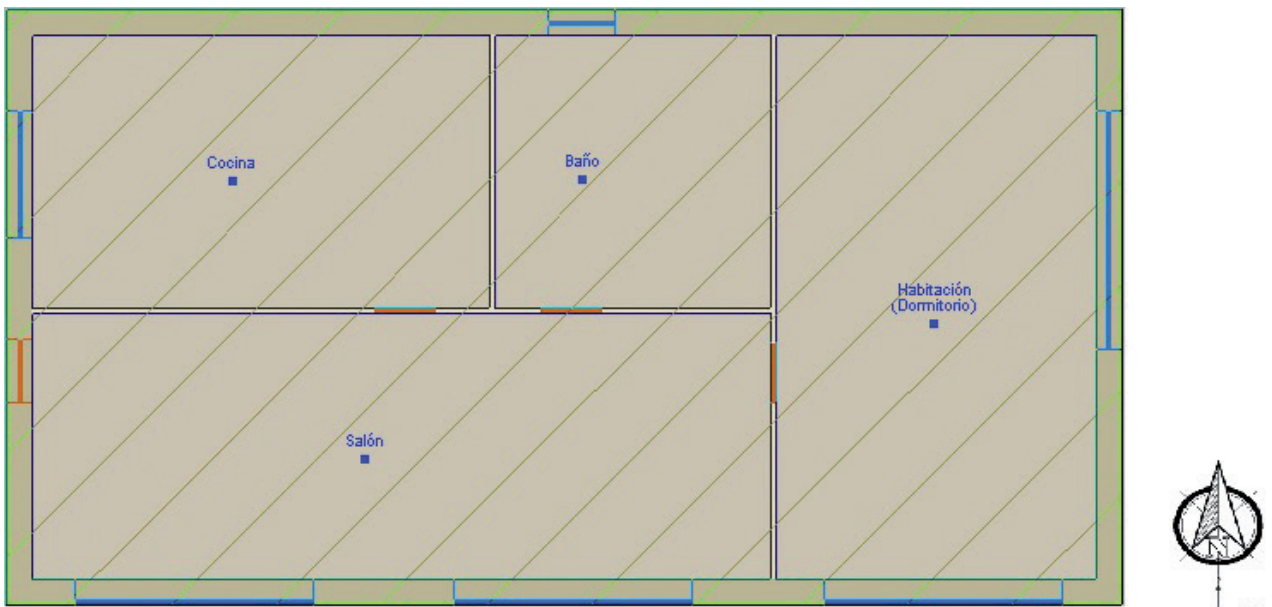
Planta con la distribución interior del edificio objeto de estudio | Figure 1. Floor plant showing the interior distribution of the building the object of the study
